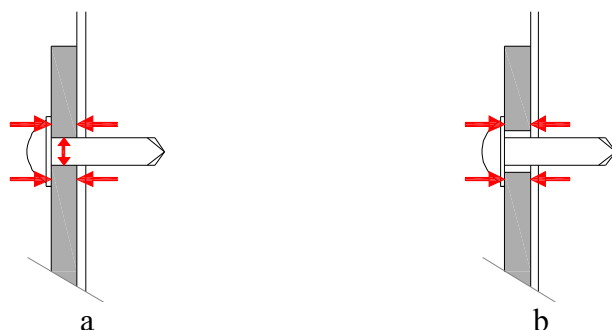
reações entre ancoragem e placa cimentícia no ponto fixo; a: ponto fixo; b: ponto móvel
